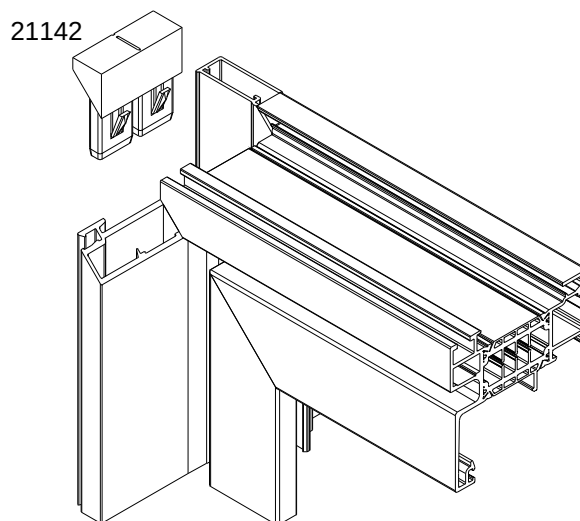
DETAILS D'ASSEMBLAGE DORMANT EN PARTIE HAUTE - Passage VR
